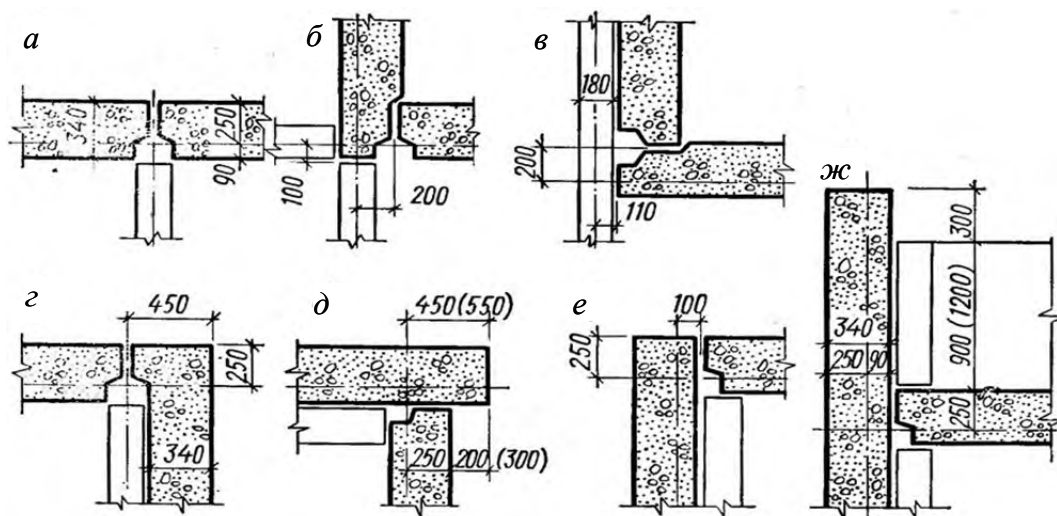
Сопряжение в углах панелей наружных и внутренних стен:
